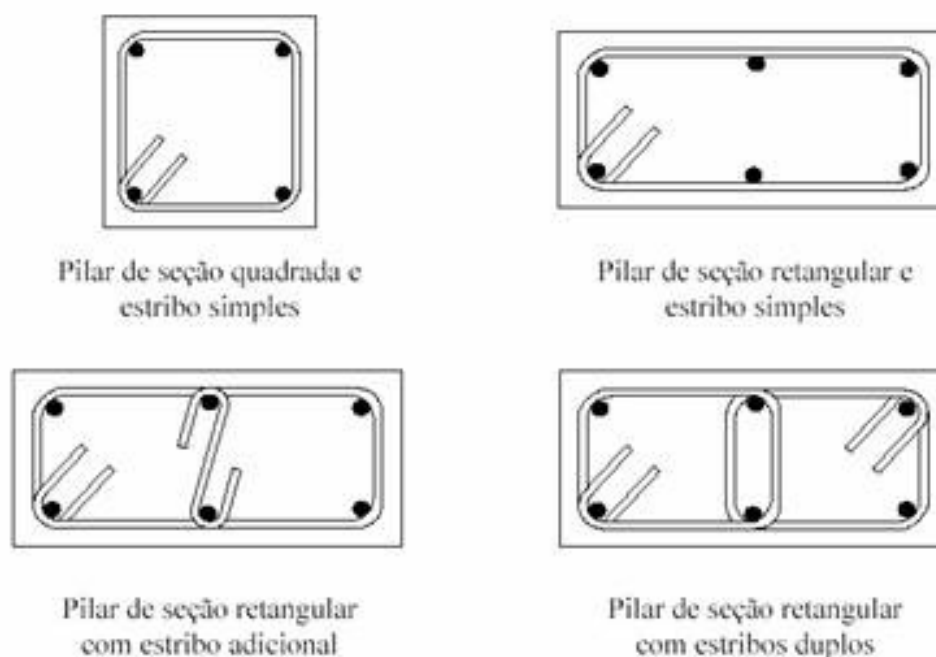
Seções e configurações de armadura mais empregadas em pilares de concreto armado (OLIVEIRA, 2004)
